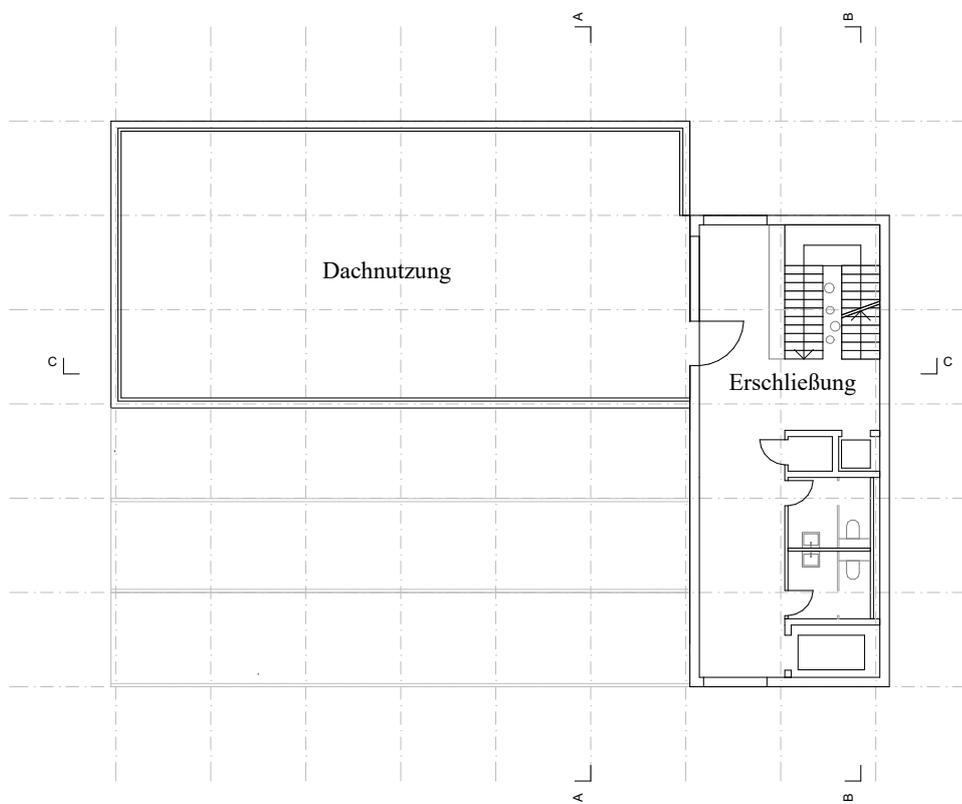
Grundriss Dachgeschoss, M 1:250
